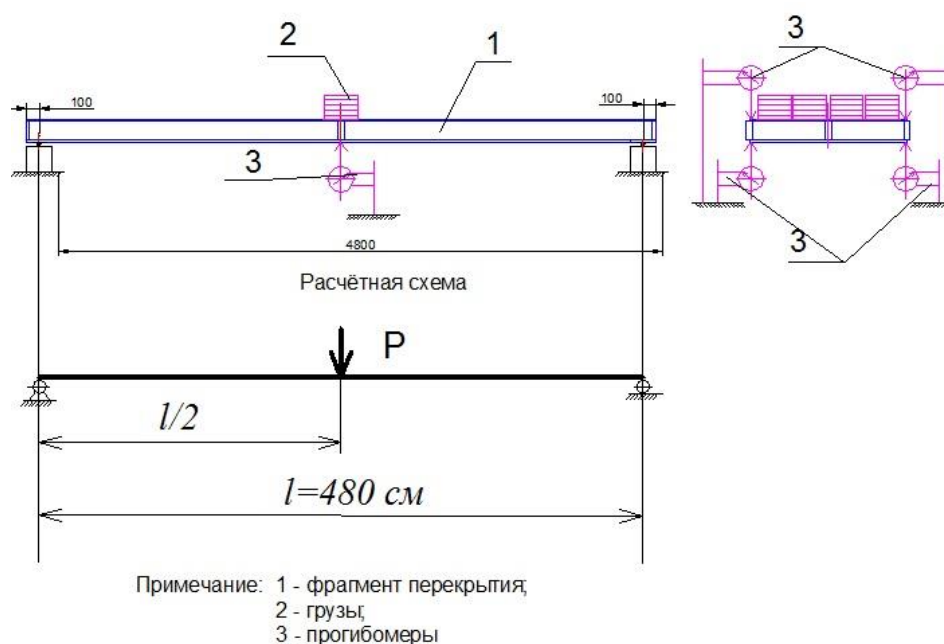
Схема нагружения и расчётная схема плиты перекрытия
